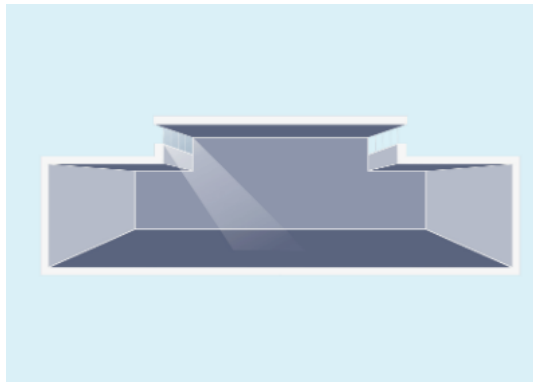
Tragaluz Tipo Linterna. Fuente: Archdaily, 2018.
